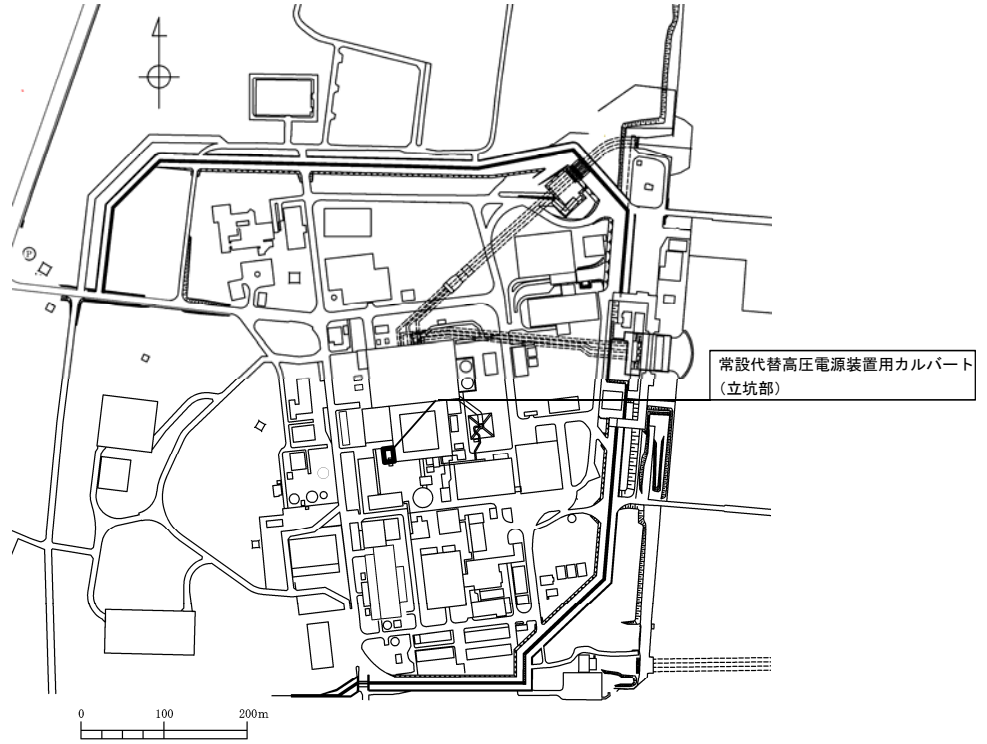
(1) 立坑の平面配置図 (全体平面図)
